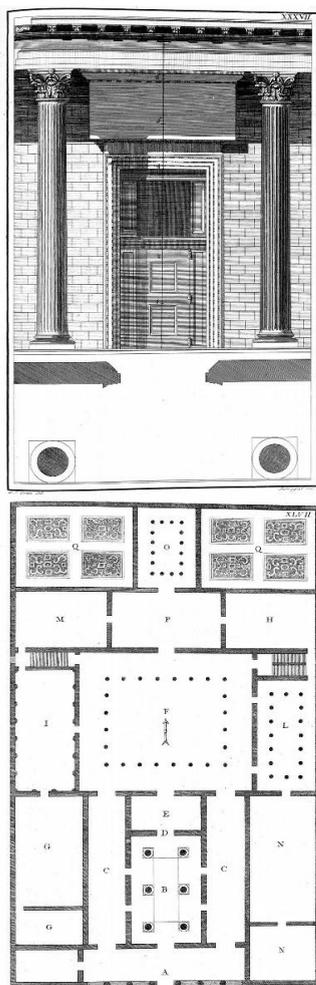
a | b. Láminas XXXVII (Planta y Alzado de la Puerta Corintia) y XLVIII (la Casa Romana)
